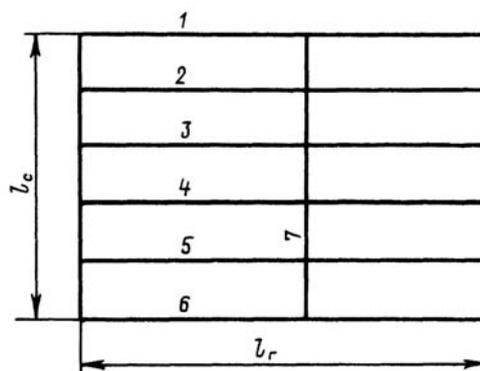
Схема перекриття з чотирма горизонтальними рамами:
